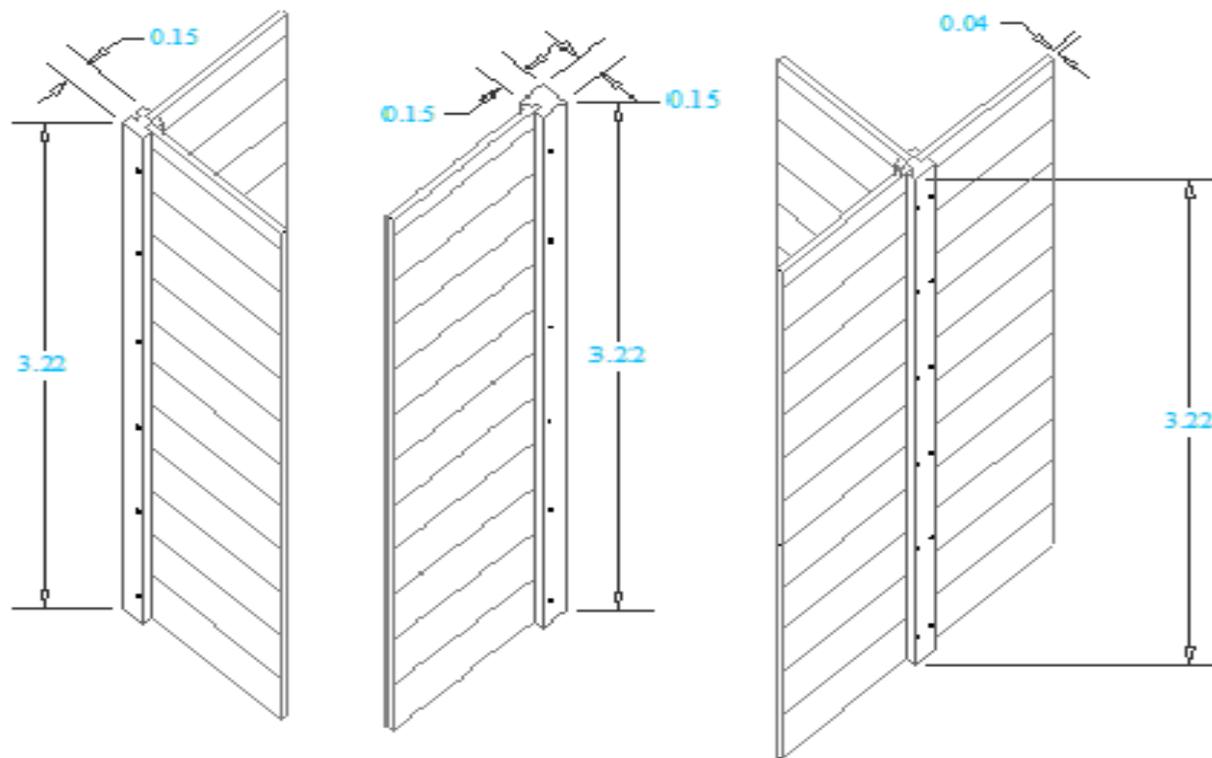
Detalle del tablón y ensamblaje de la estructura
